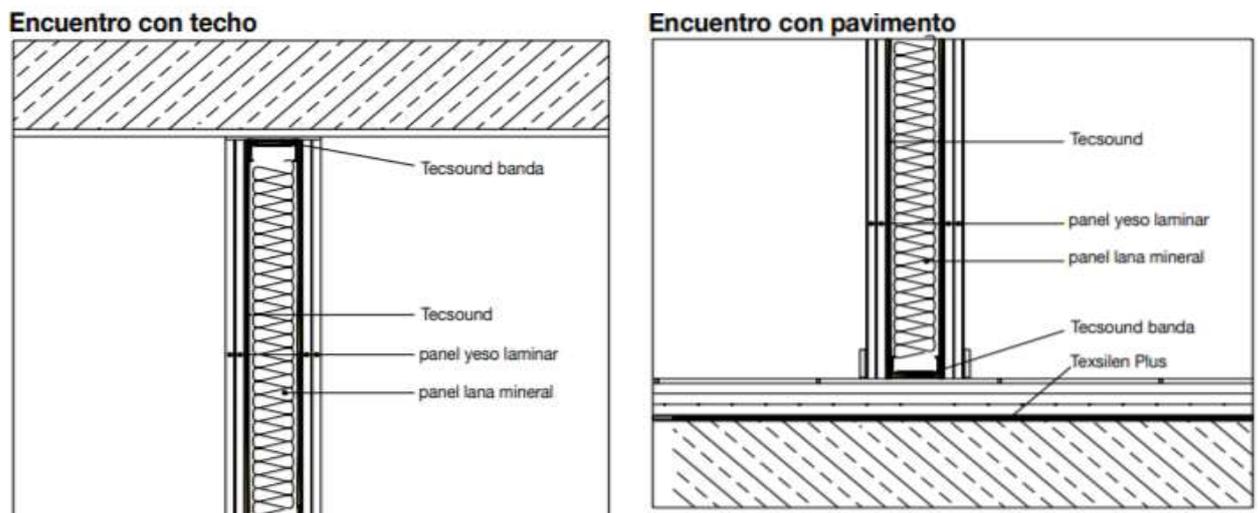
Encuentros de aislamiento con techo y pavimento para espacios interiores
